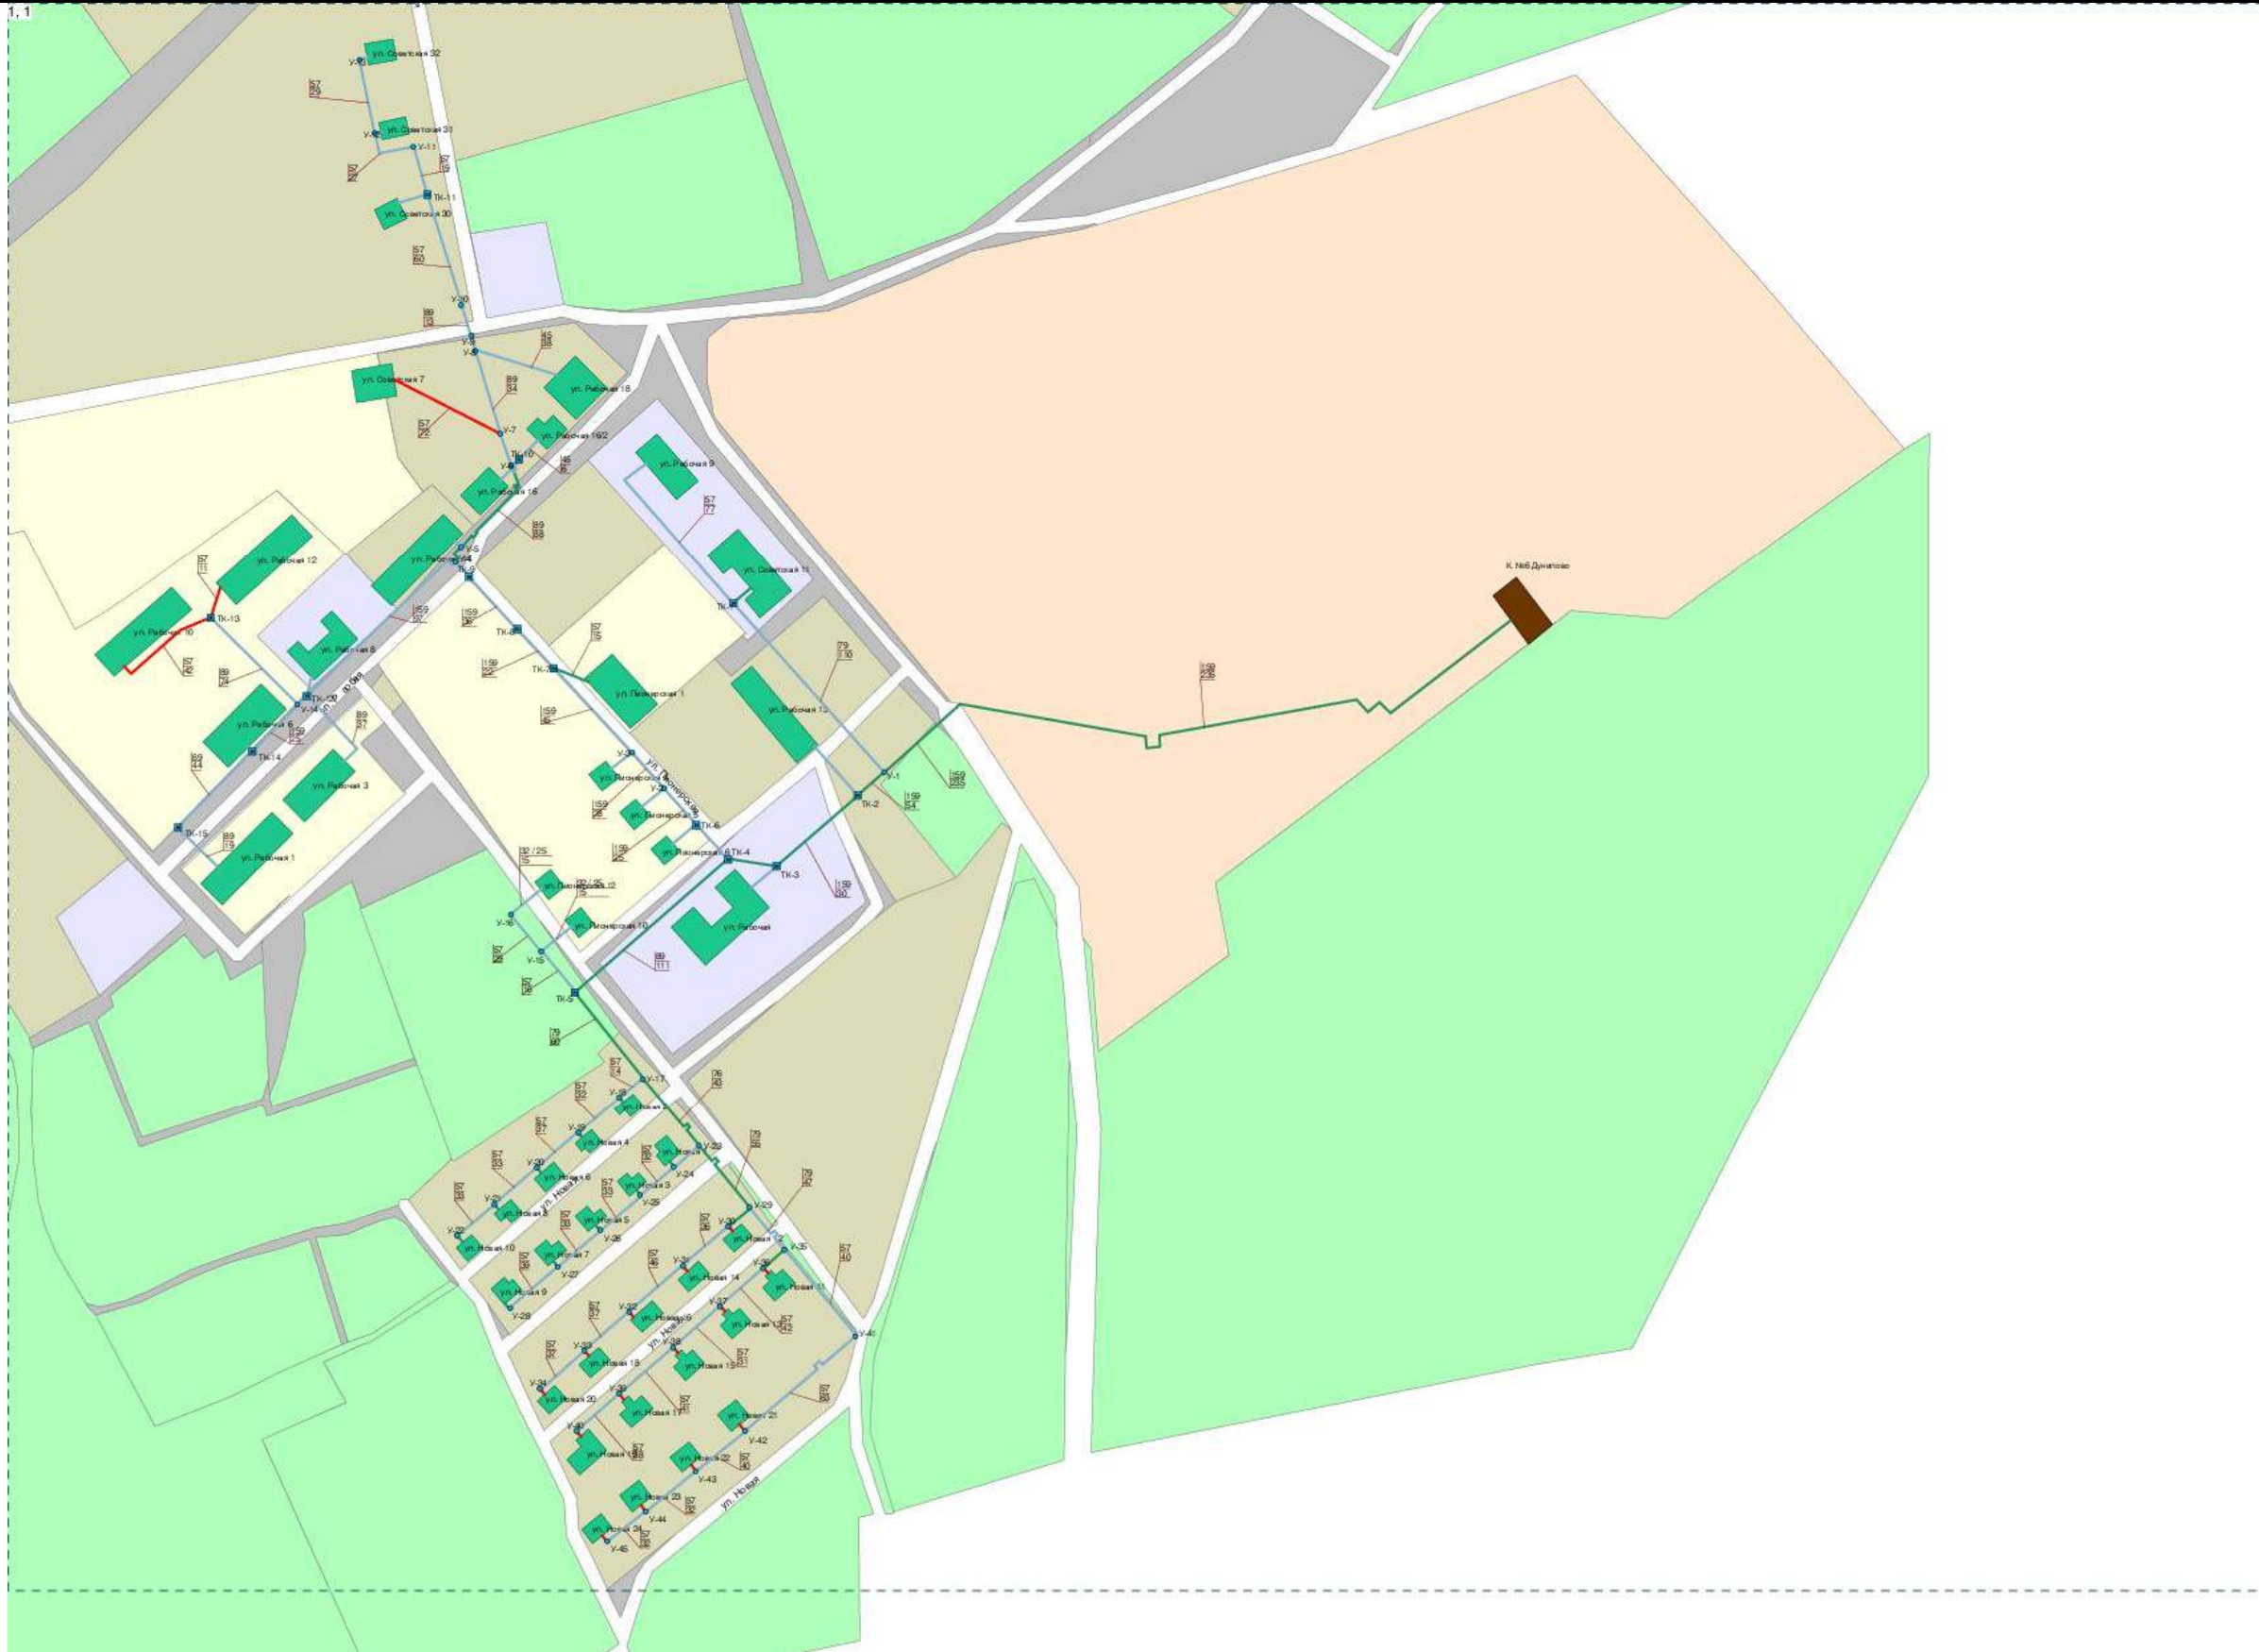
Схема тепловых сетей от котельной № 6 с. Дунилово
